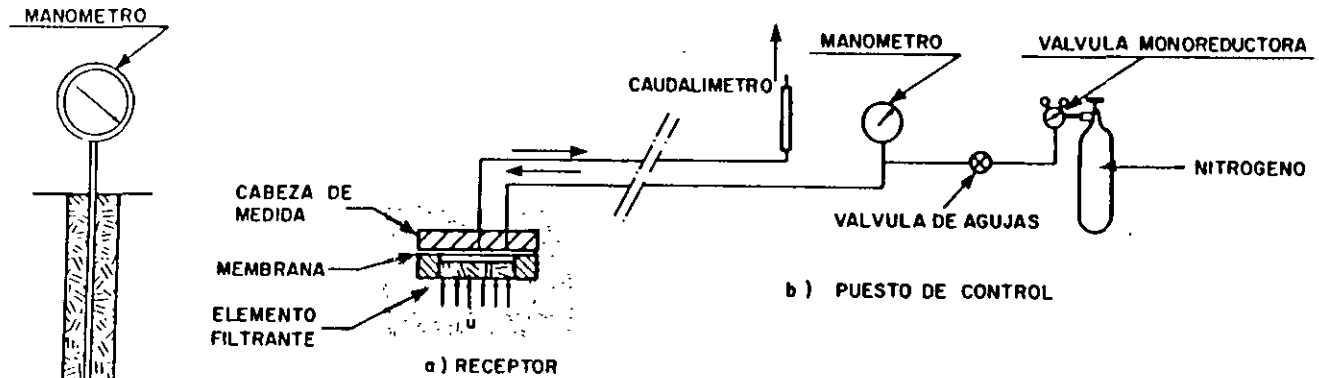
34 — Piezómetro tipo "Casagrande" equipado con piezómetro hidráulico
